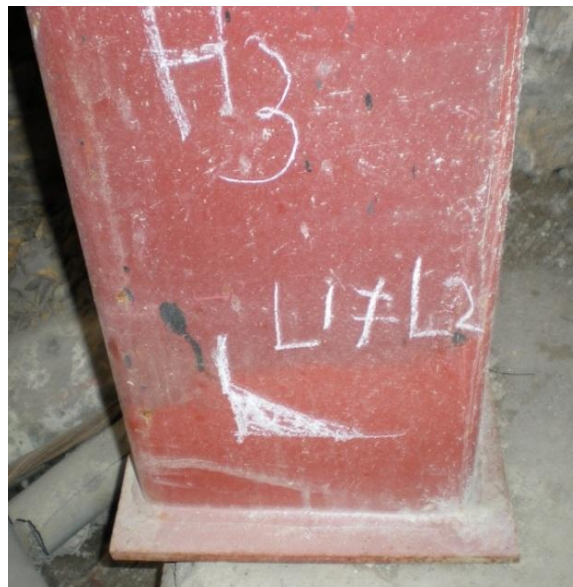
Defecto de soldadura en unión placa base – columna
